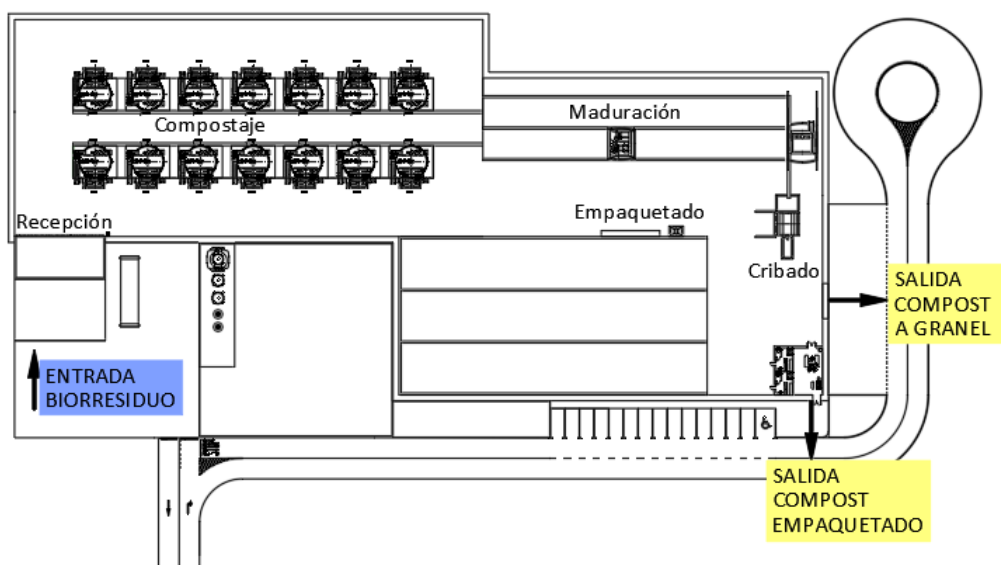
Estructura general de la planta de compostaje. Fuente: Elaboración propia
